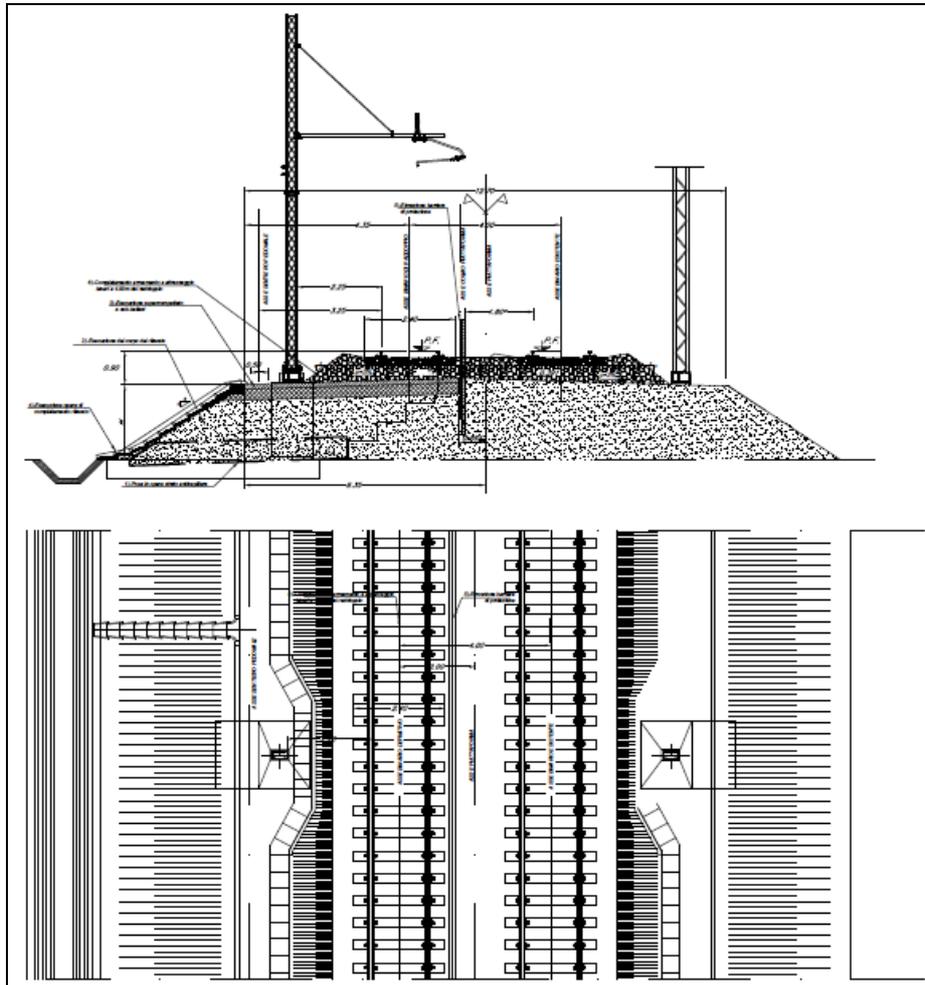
Sezione Tipo in Rilevato in Affiancamento
